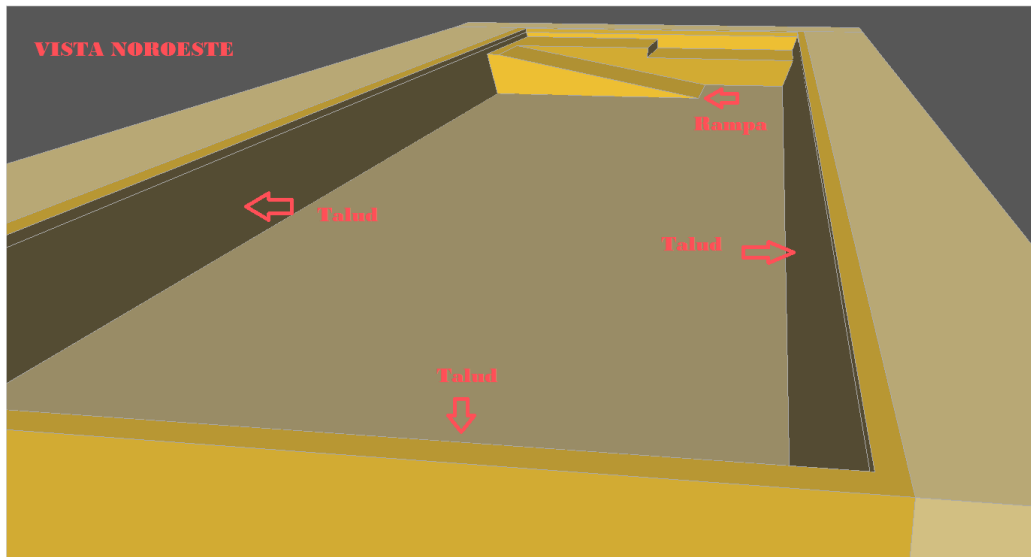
Esquema de la excavación del subsuelo (vista noroeste).
